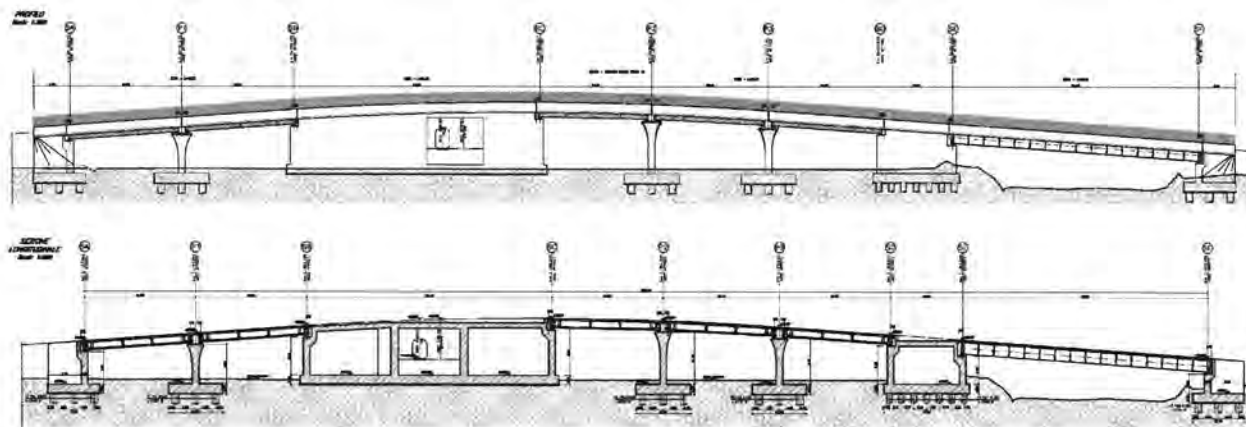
Prospetto e sezione cavalcaferrovia
